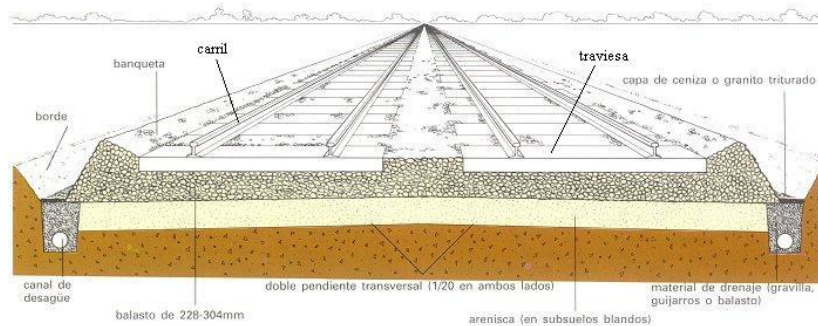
Sección típica de una vía con balasto. Fuente: Vidal (2009)
